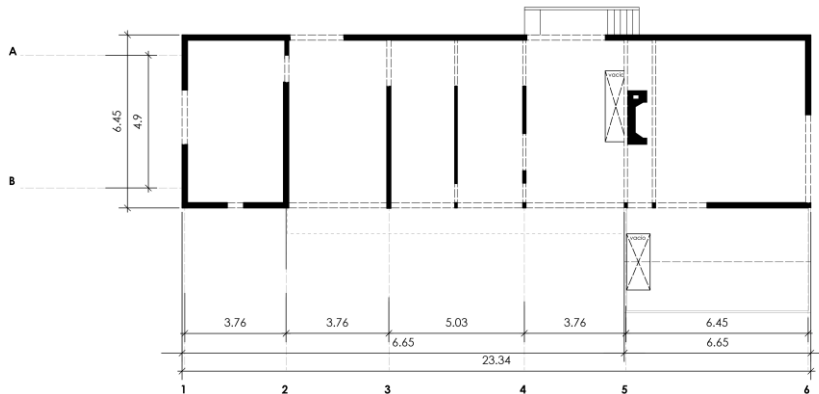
Esquema gráfico de la modulación estructural en planta baja. Fuente: Autor.
